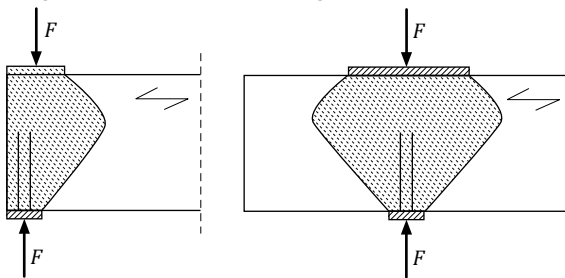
Lastausbreitung bei direkter Lagerung nach [5]
